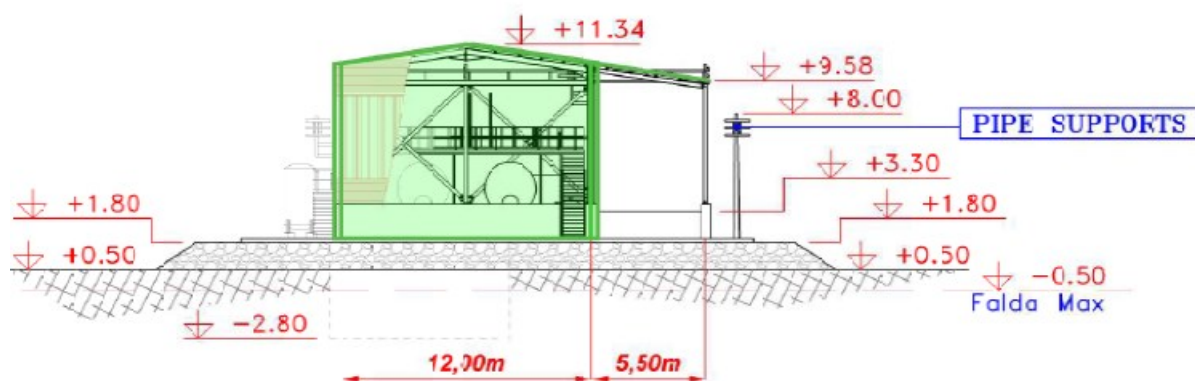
Pianta edificio stoccaggio ammoniaca
